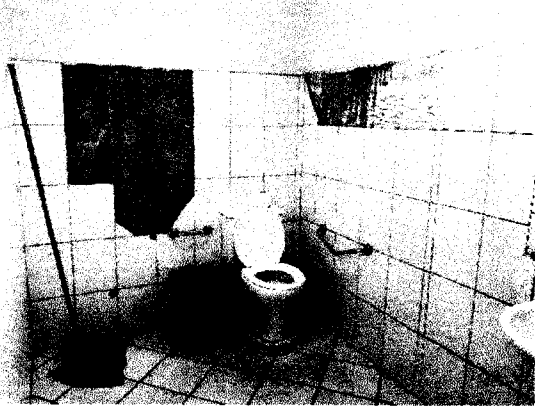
BANHEIRO PNE DO PAVIMENTO TÉRREO.
